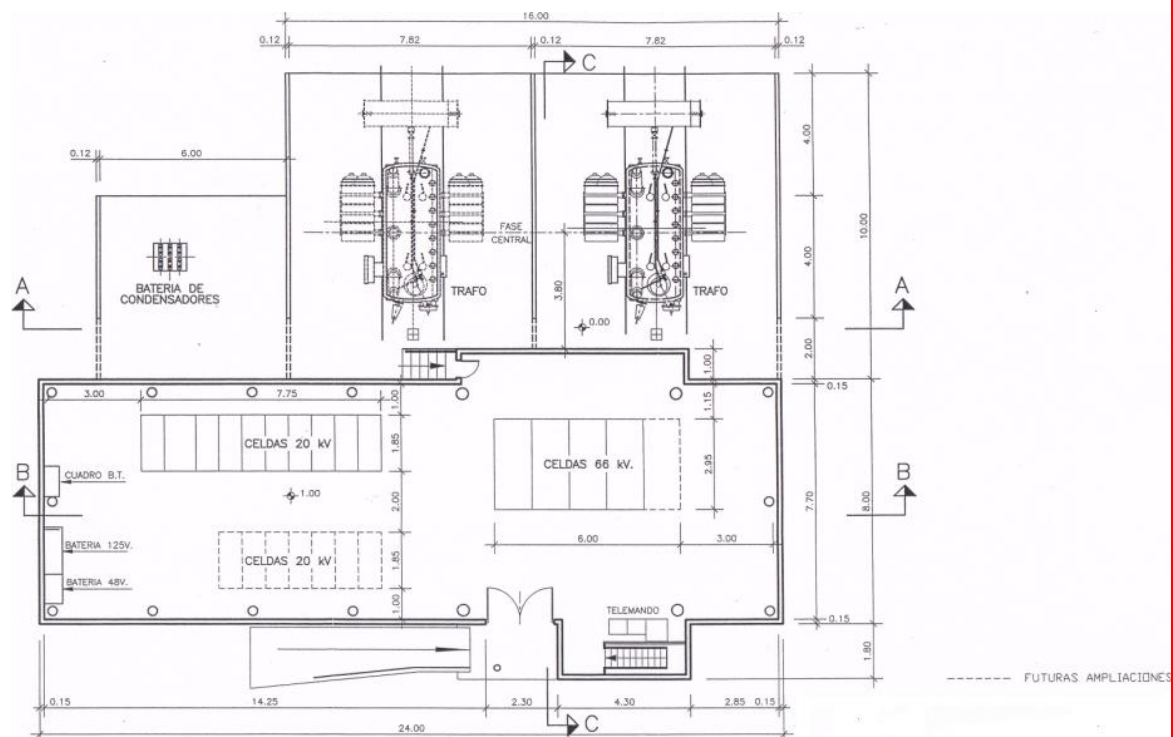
Plano de plantas de una subestación blindada urbana subterránea de 132/20 kV.
